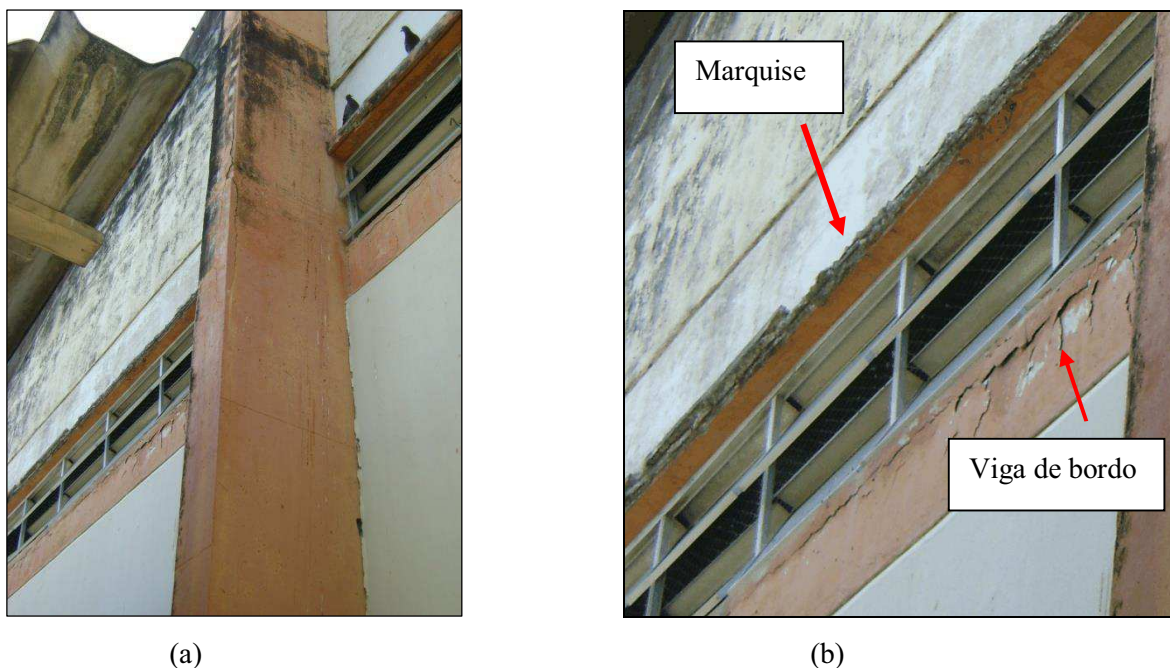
(a) Presença de bolor na parte superior e ausência na parte inferior do Pilar P41 (b) detalhe da marquise apresentando armadura exposta e viga de bordo com fissuras de corrosão de armadura.
